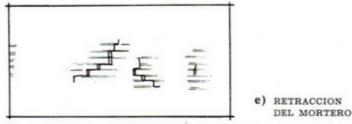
FISURAS EN LOS MUROS DE OBRA DE FABRICA
